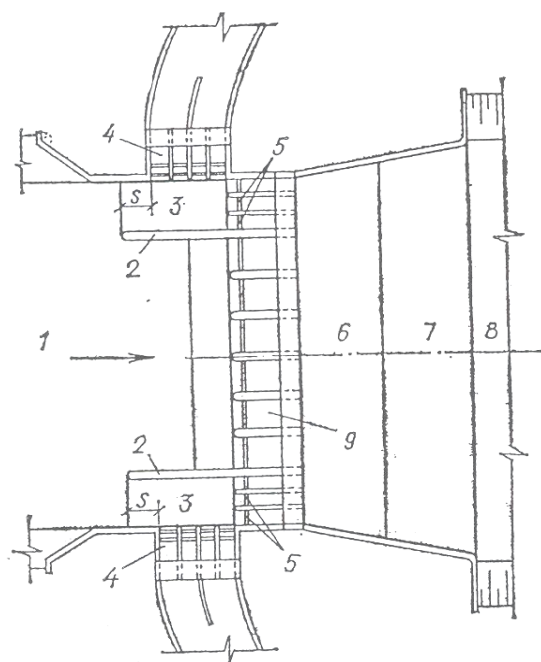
Боковой водозаборный гидроузел с «карманами»: 1 – подводящее русло; 2 – раздельная стенка; 3 – «карман»; 4 – водоприемники; 5 – промывники; 6 – водобой; 7 – рисберма; 8 – отводящее русло; 9 – водосброс
